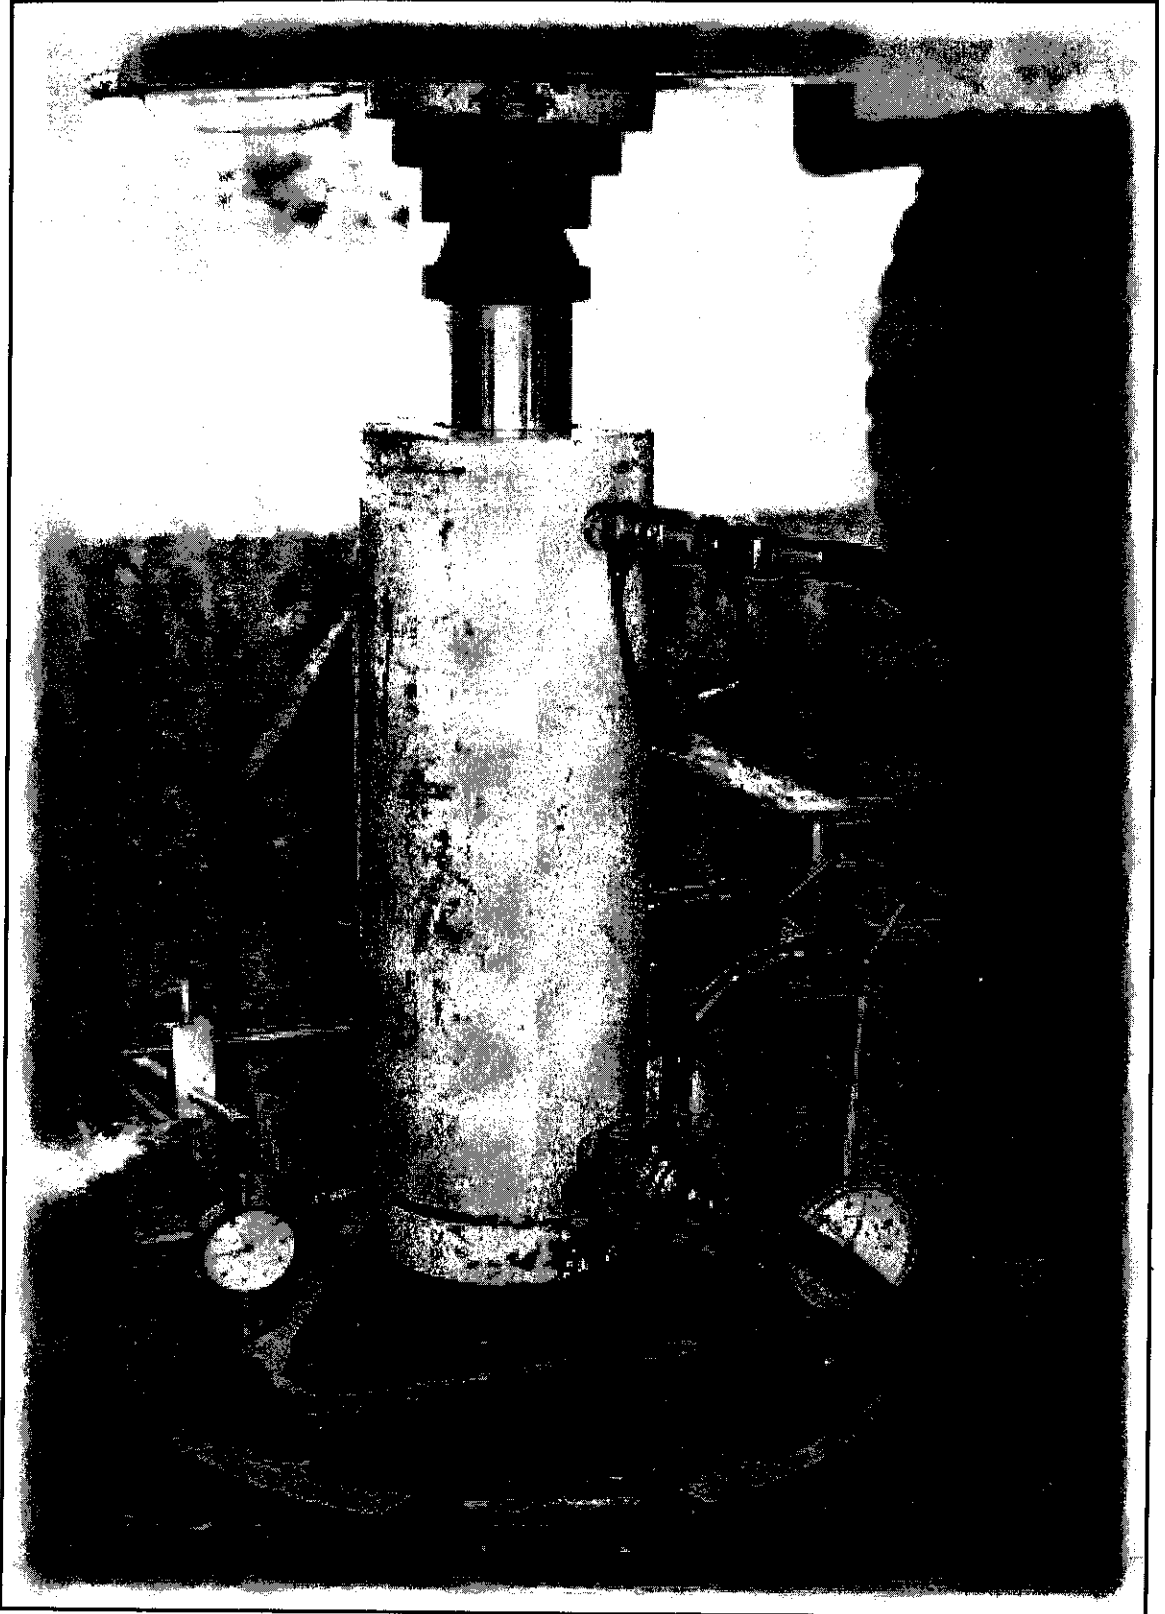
Equipo en el Laboratorio de Estructuras del Departamento de Ingeniería CONCYTEC, para pruebas de calidad del concreto.
